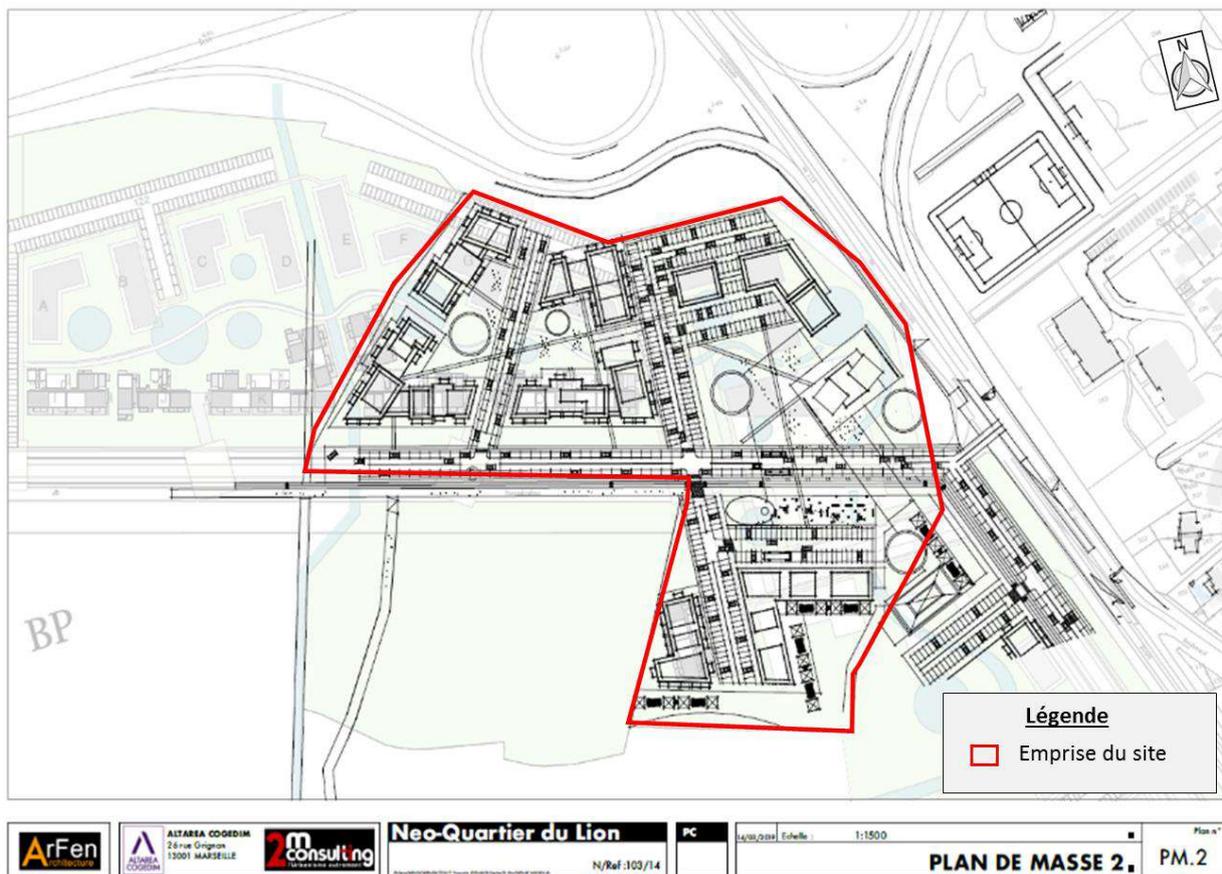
Plan de masse du projet et projet urbain (Source : ALTAREA COGEDIM, 2019)
